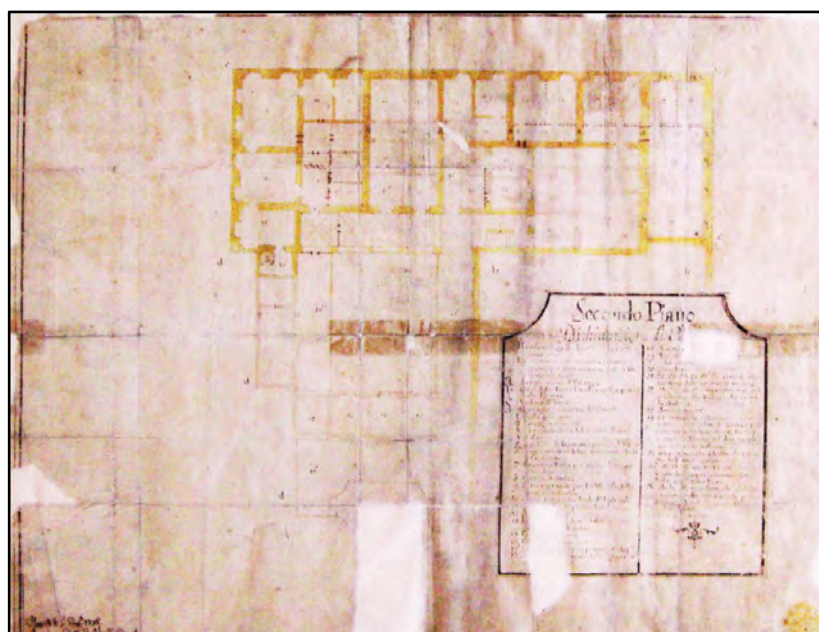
Agostino Caputo, Progetto per la Real Caccetta di Procida, 1738, Pianta del secondo piano, Napoli, Archivio di Stato.
